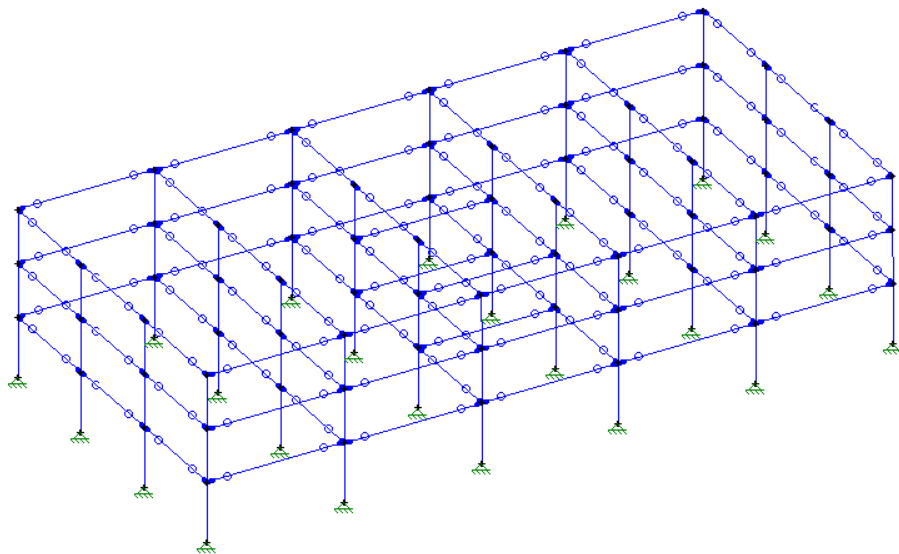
Estrutura com Ligações Articuladas Seção Fissurada – 3PAV
